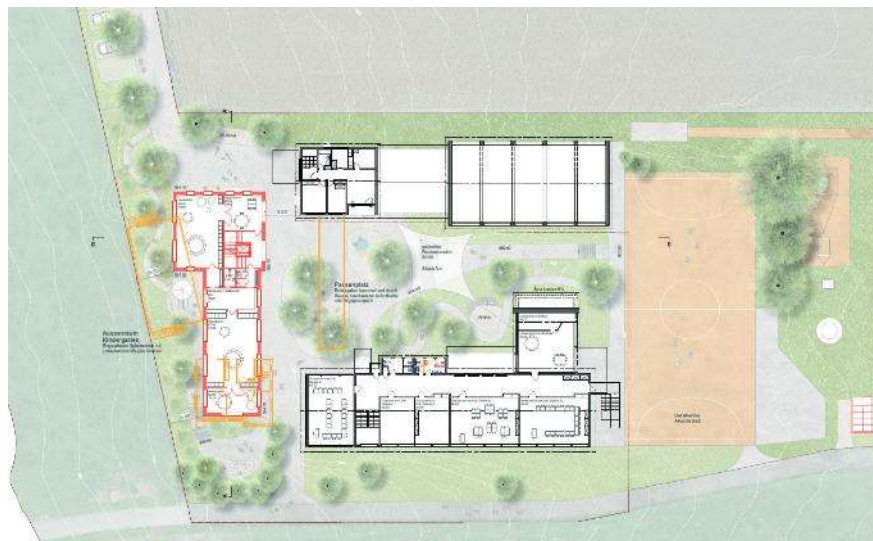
Schlussabgabe, Grundriss Obergeschoss des Team Balmer Architektur GmbH mit Rig-genbach GmbH Garten und Landschaft
